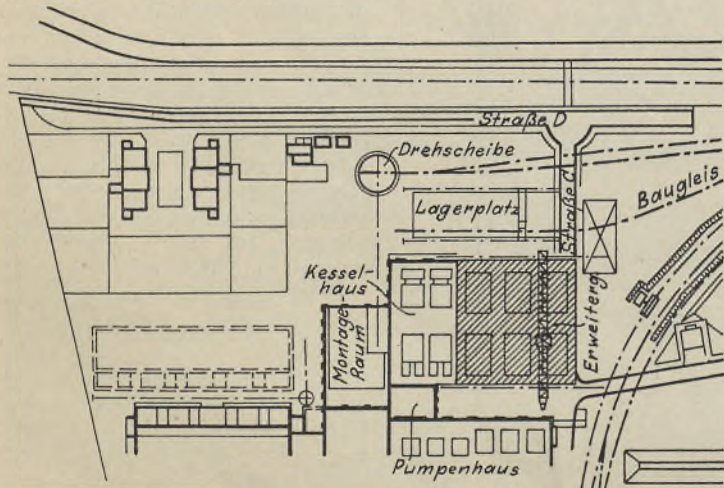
Übersichtsplan der Baustelleneinrichtung.
